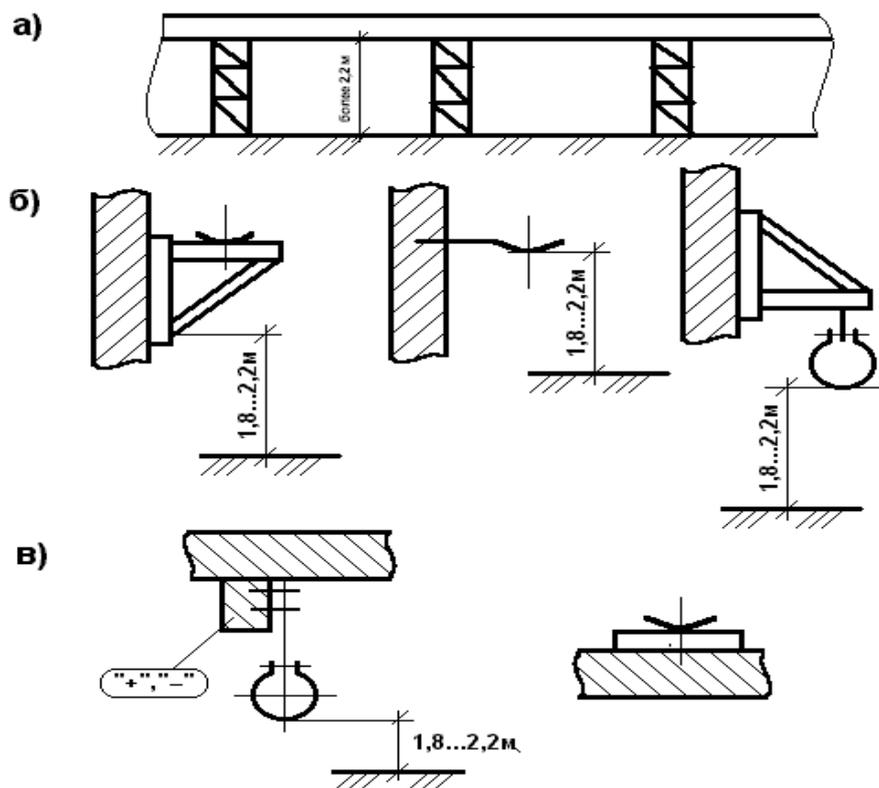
Способы прокладки трубопроводов открытым способом; а, б, в – соответственно, по опорам, по стенам, по перекрытиям.
